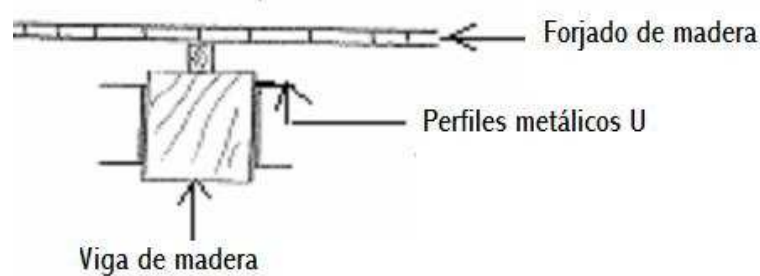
Consolidación de forjados mediante la consolidación de vigas
